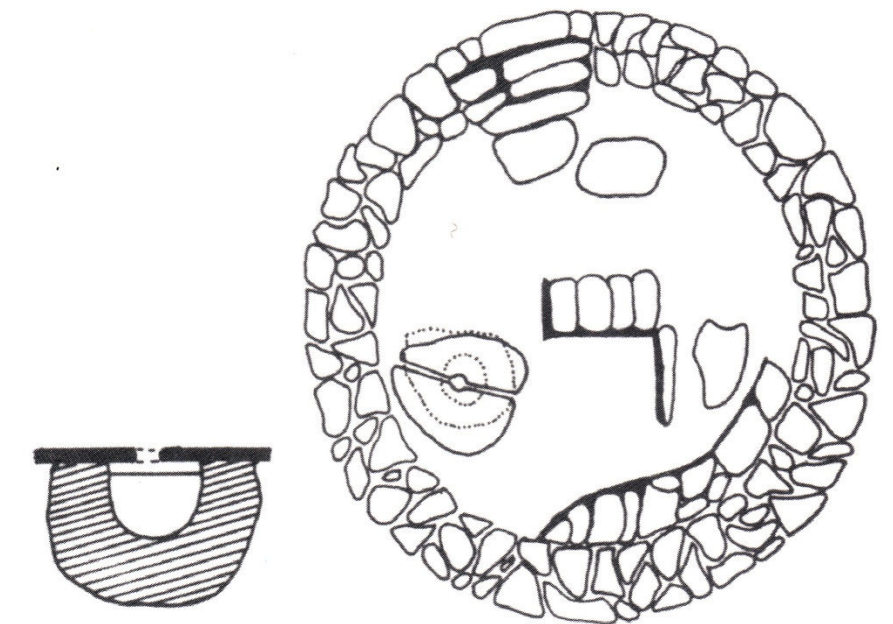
Planta de una cabaña del Castro de Pendia y sección de la “piedra con cazoleta” documentada en su interior. En la planimetría elaborada por García y Bellido se pueden observar los siguientes elementos: el piso de la estancia se encuentra a una cota inferior con respecto al espacio circundante, unas escaleras ayudan a salvar el desnivel; el suelo de la vivienda en origen parece que estuvo, al menos en una parte, solado; los restos de enlosado que se representan hacen sospechar esa probabilidad; un hogar central junto a una “piedra con cazoleta”, provista de una tapa o losa de pizarra que la cubre, sirven como ejemplo para la organización del espacio en una cabaña de dimensiones reducidas. Un banco corrido o alacena completan el repertorio de elementos de obra presentes en alguna de estas construcciones.
